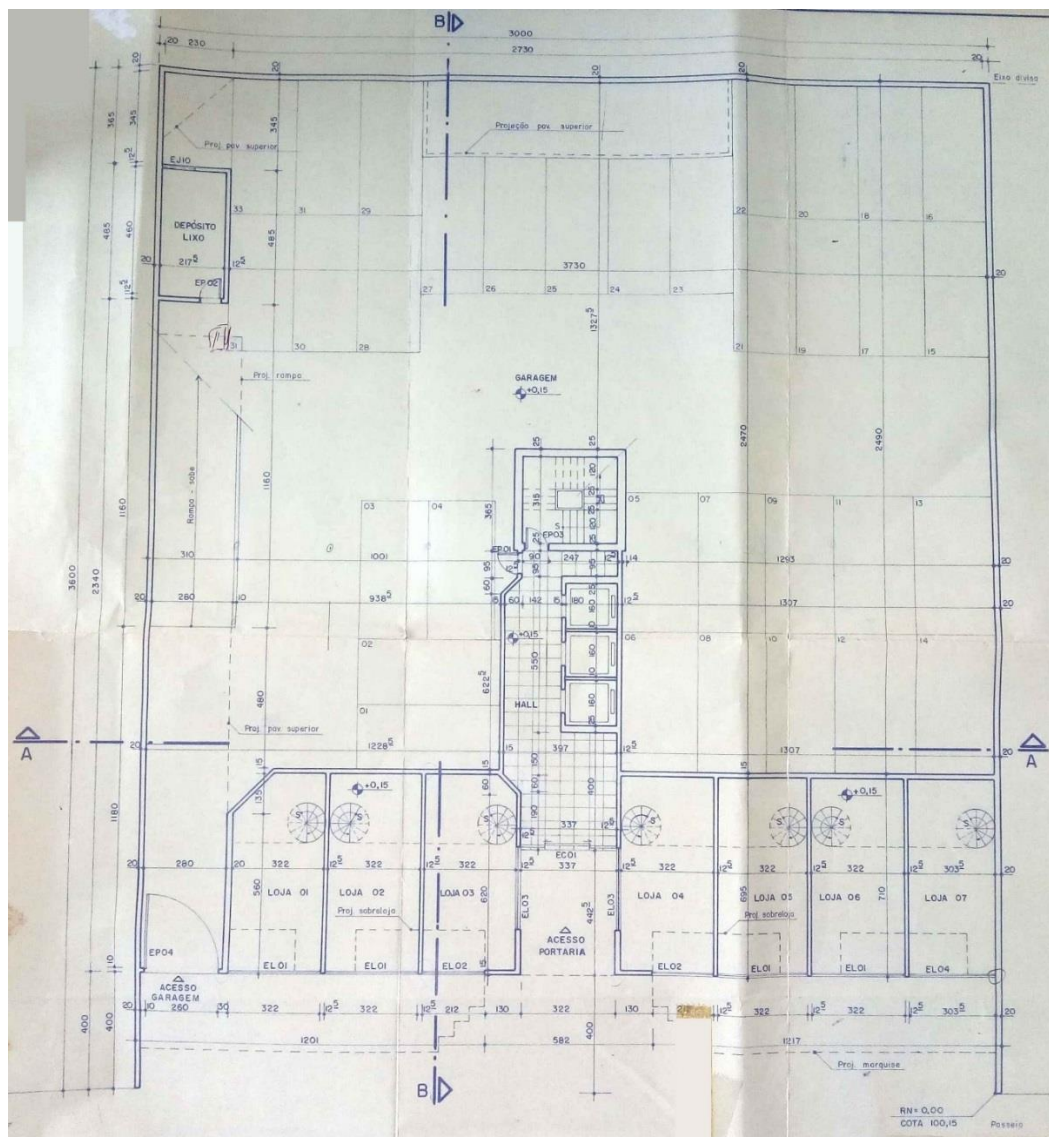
Planta do pavimento térreo (primeiro nível de garagem e lojas).
